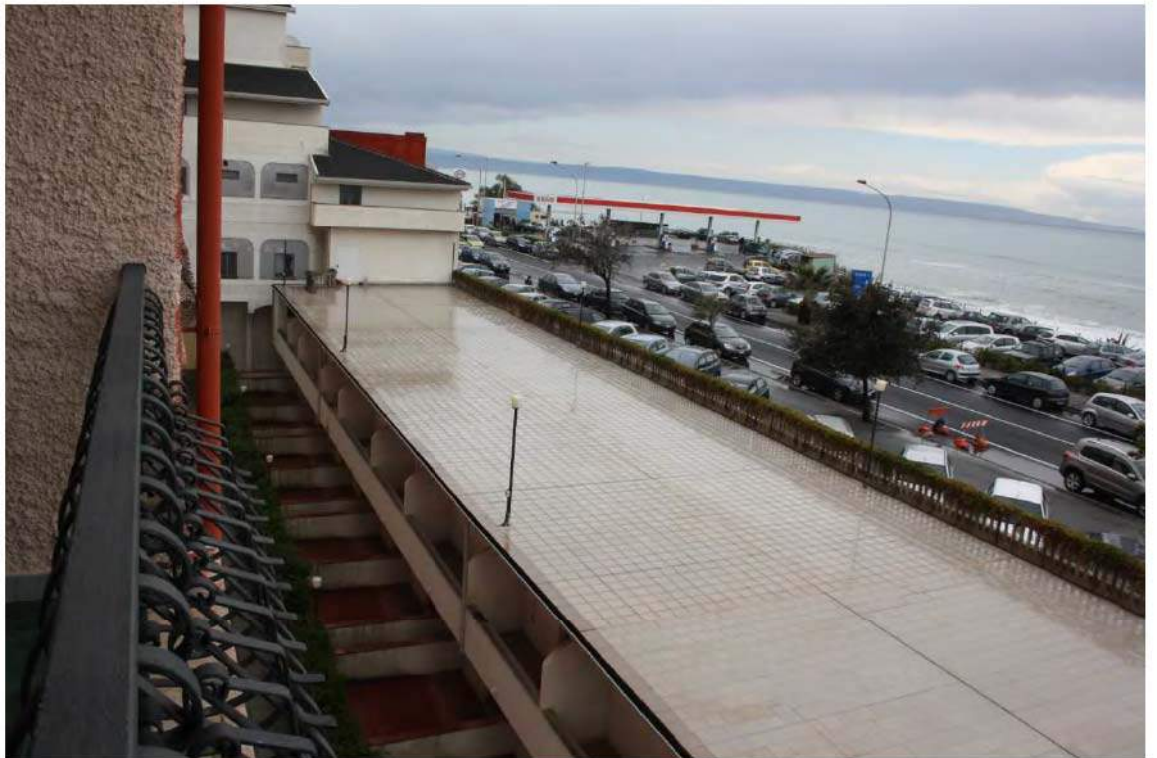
BALCONCINO LATO EST PIANO SECONDO
